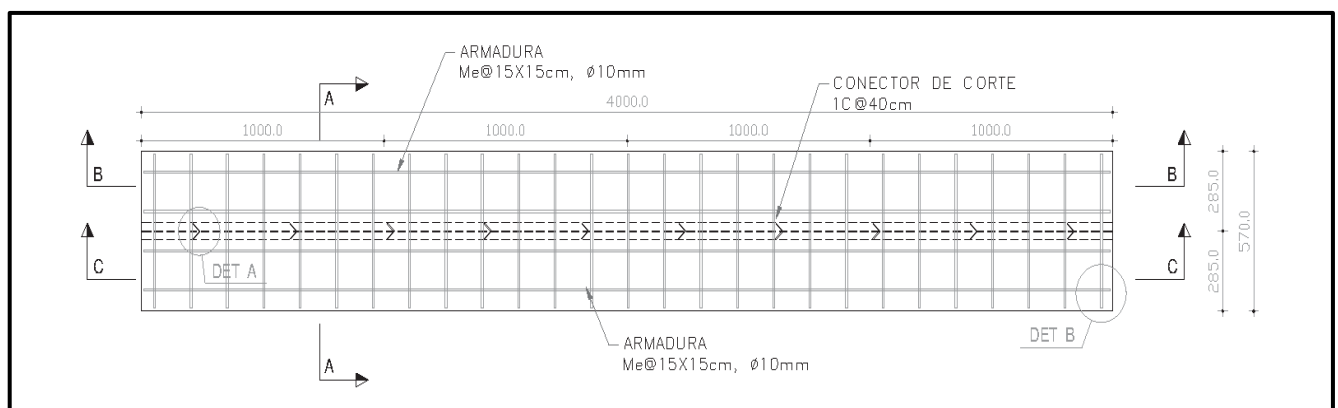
Dimensiones de losa de concreto armado con fibras de acero.
